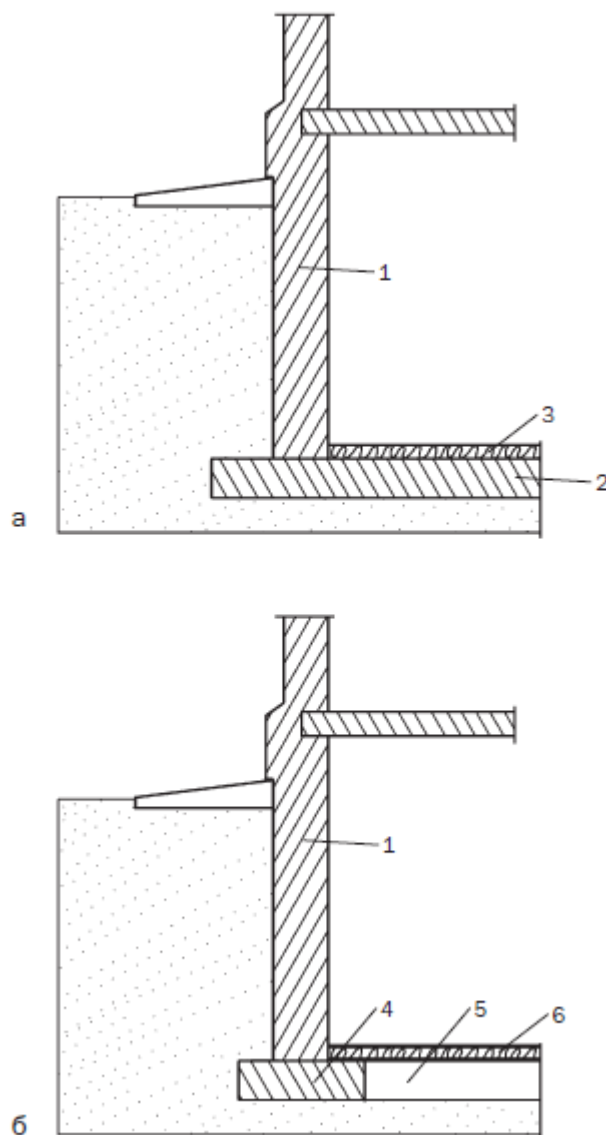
Схема устройства подвального помещения: а – на монолитной плите; б – на ленточном фундаменте; 1 – стена подвала; 2 – плита; 3 – бетонная стяжка; 4 – лента фундамента; 5 – песчаная подушка; 6 – плита пола
